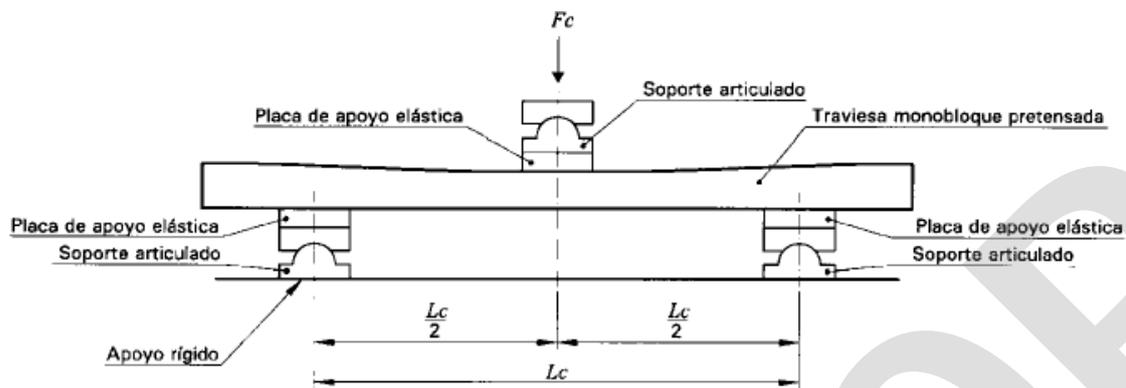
Montaje para ensayo a flexión positiva en la sección central de la traviesa
